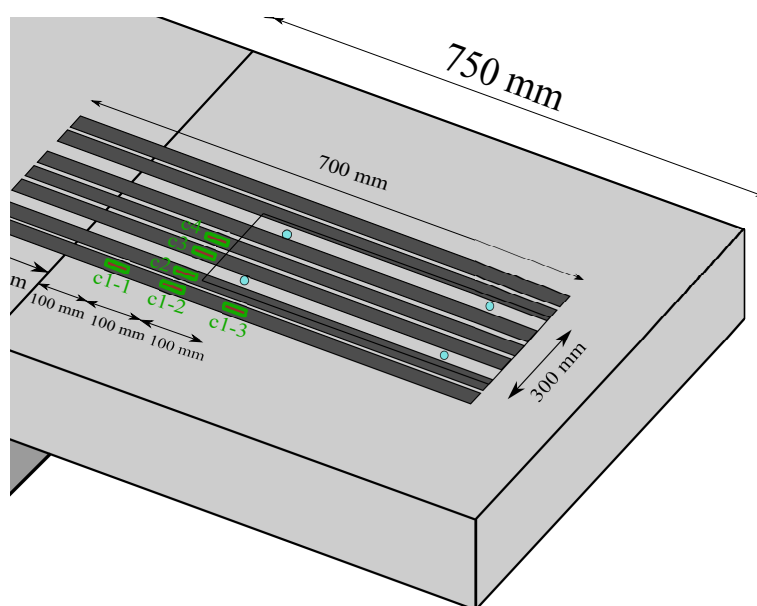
Position des jauges de déformation sur les plats en PRF de la dalle 4
